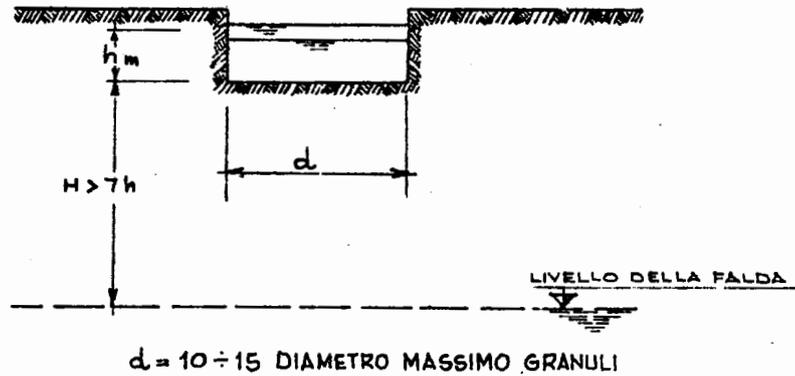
SCHEMA DELLA PROVA DI PERMEABILITA' IN POZZETTO SUPERFICIALE.
